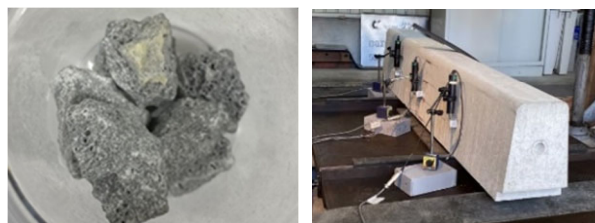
フェロクロムスラグ骨材 写真-2 ブロック製品
